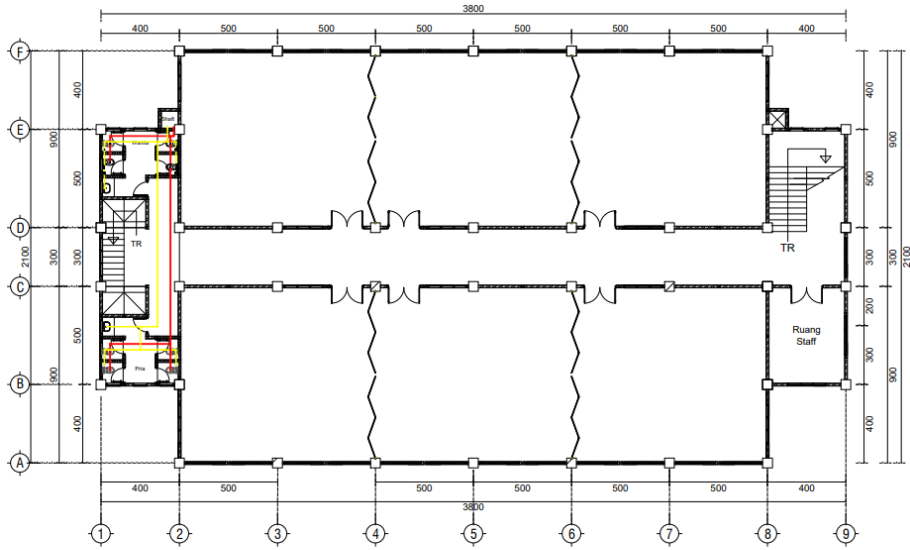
Rencana kerja instalasi air kotor lantai 2
